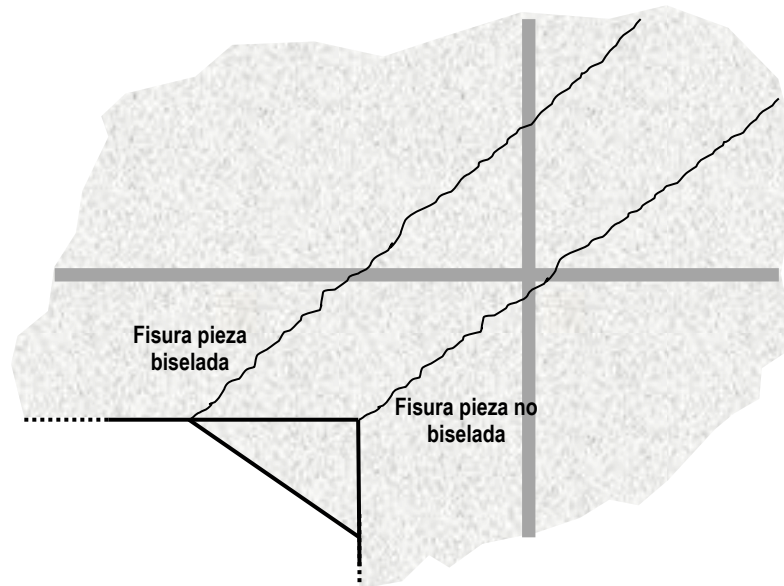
Posición de fisuras en piezas p71/O.1 (DEB-1.8, DEB-3.6)
